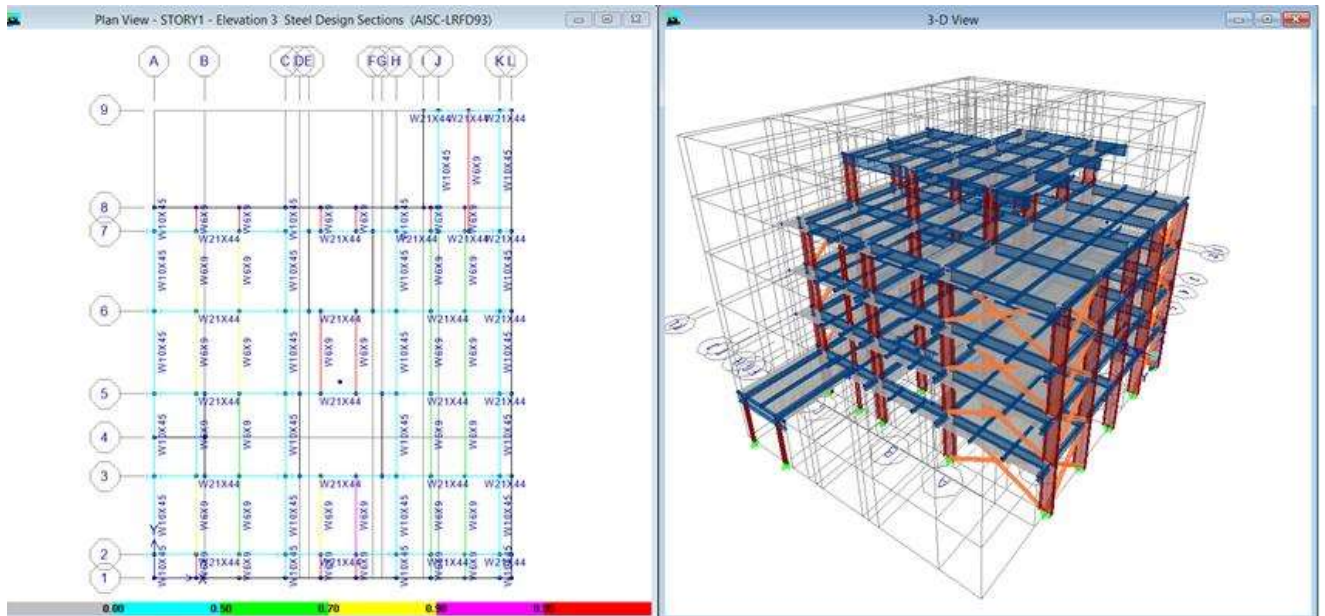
vista de planta y 3d del edificio diseñado de acero estructural con su predimensionamiento
